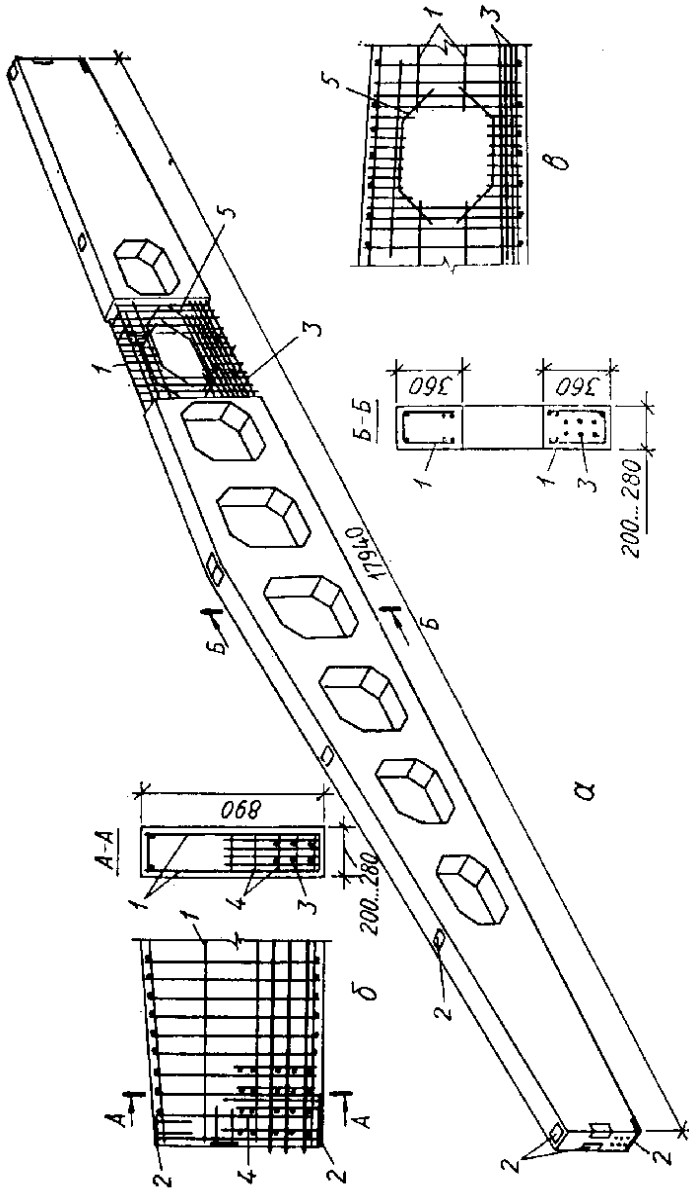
Двоскатна грагчаста балка покриття:
